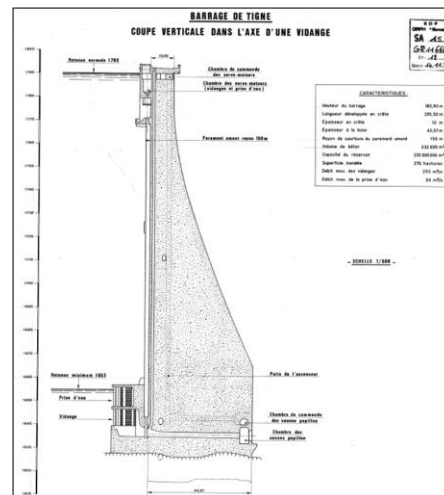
vue générale (amont couronnement) - Figure 2 : plan en coupe du barrage
